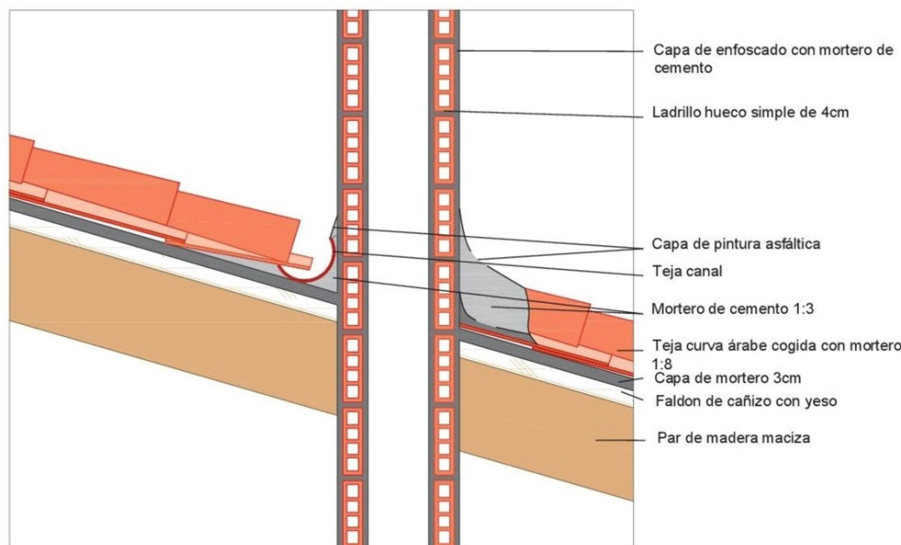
Detalle del encuentro del tejado con la chimenea del salón-comedor
